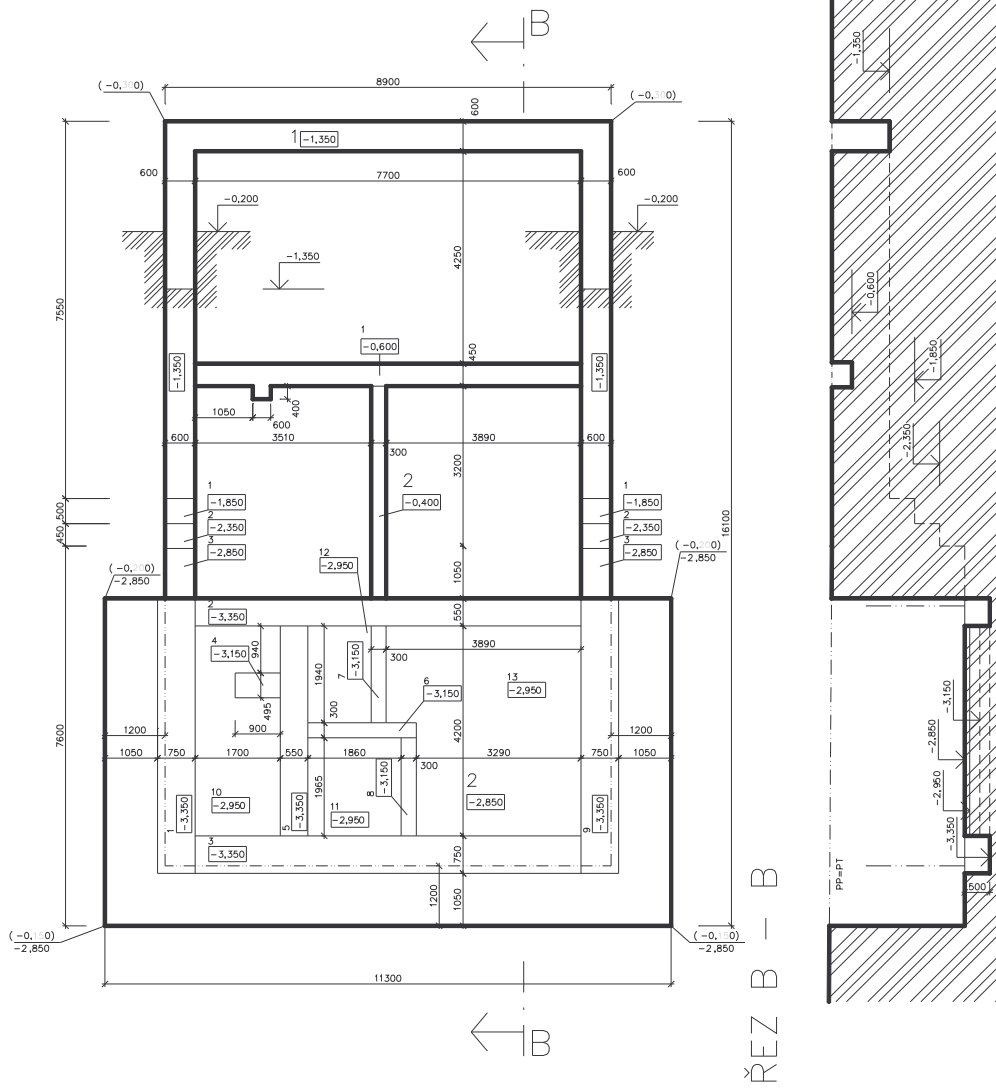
Výřez z půdorysu a řezu výkopu
